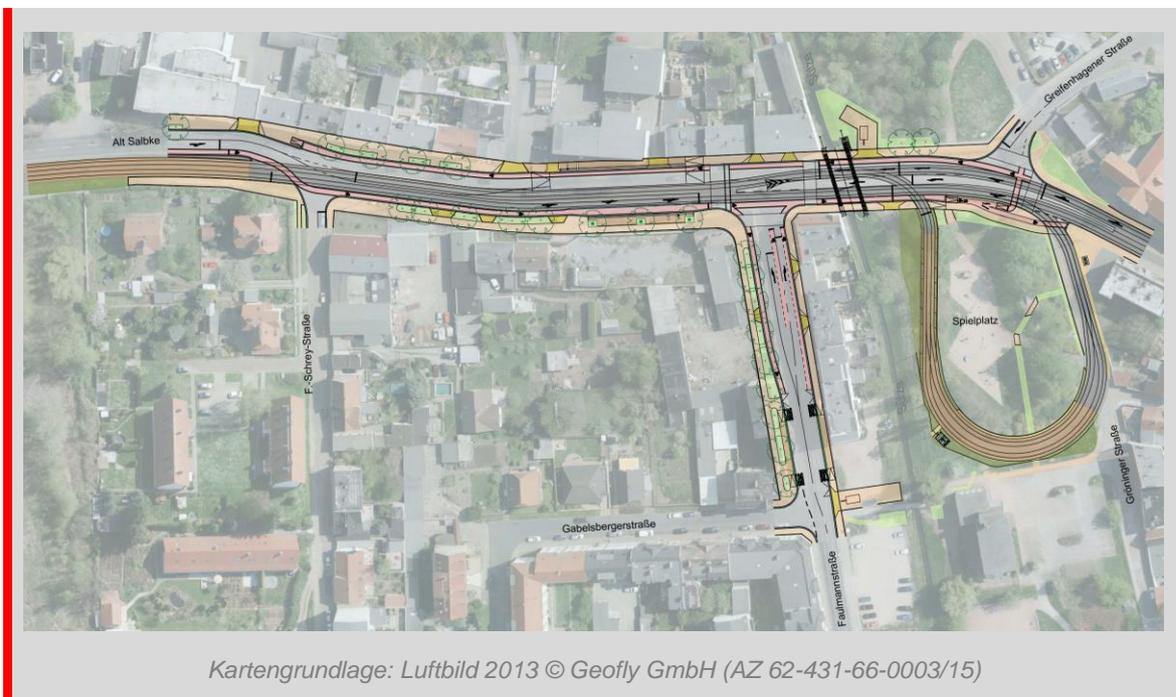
Übersichtslageplan – Ausbau Knoten Faulmannstraße
